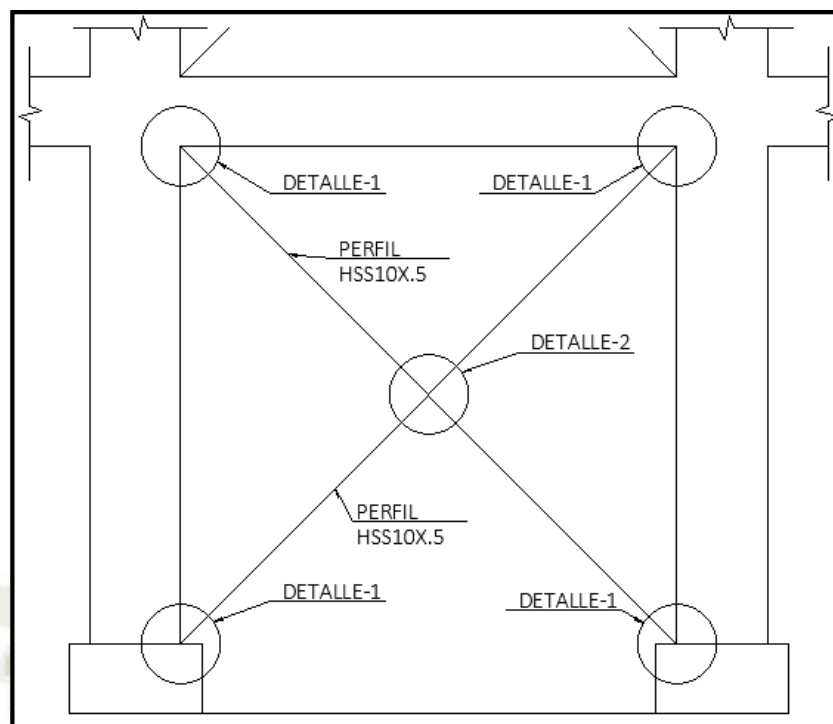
Esquema de pórtico de concreto armado arriostrado con perfiles de acero HSS10X.5. (Fuente: elaboración propia)
